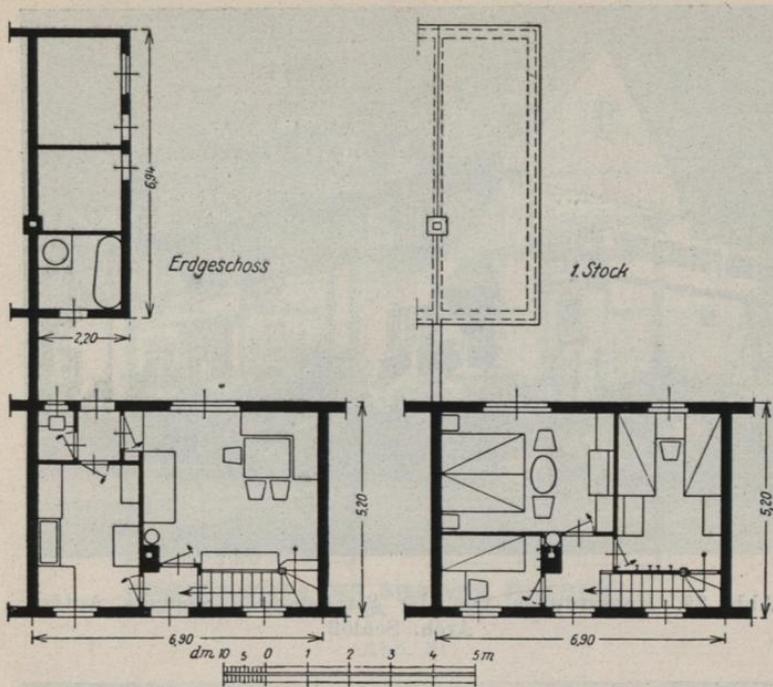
Siedlerhaus mit angebautem Stall. Arch. H. Schlöß.
